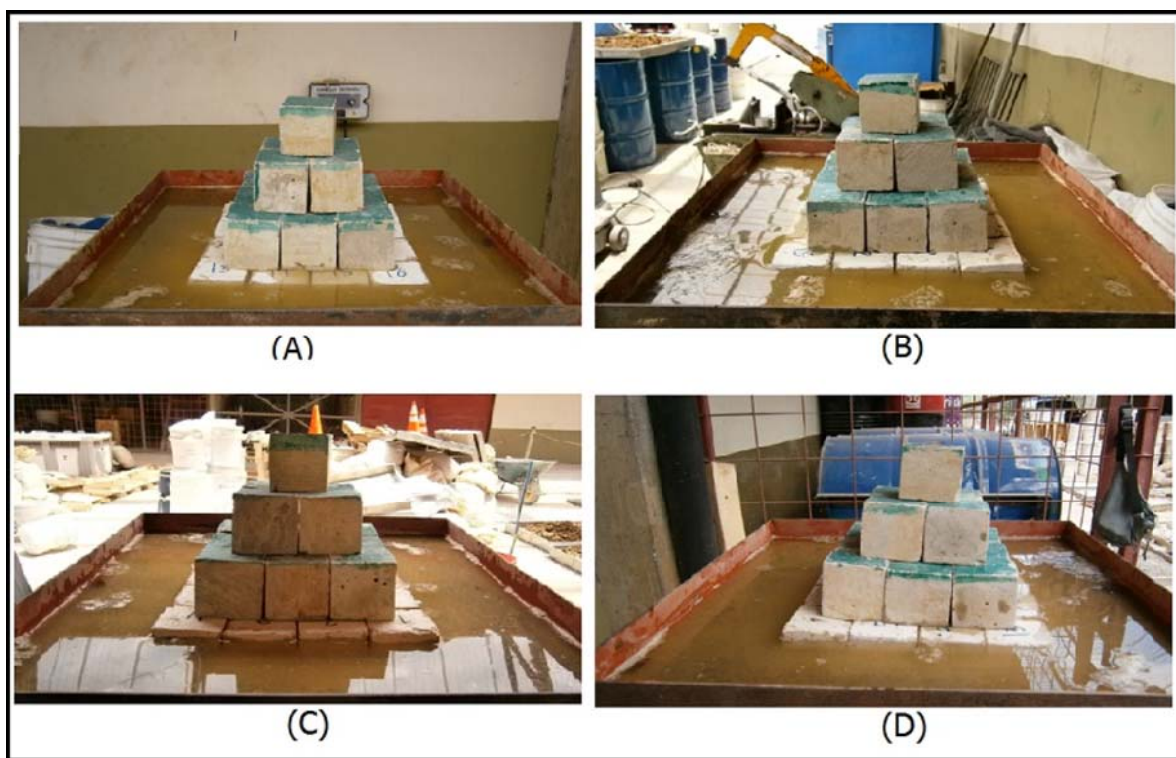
Resultado del modelo a escala combinación 50/50. (A) Fachada norte, (B) fachada este, (C) fachada sur, (D) fachada oeste
